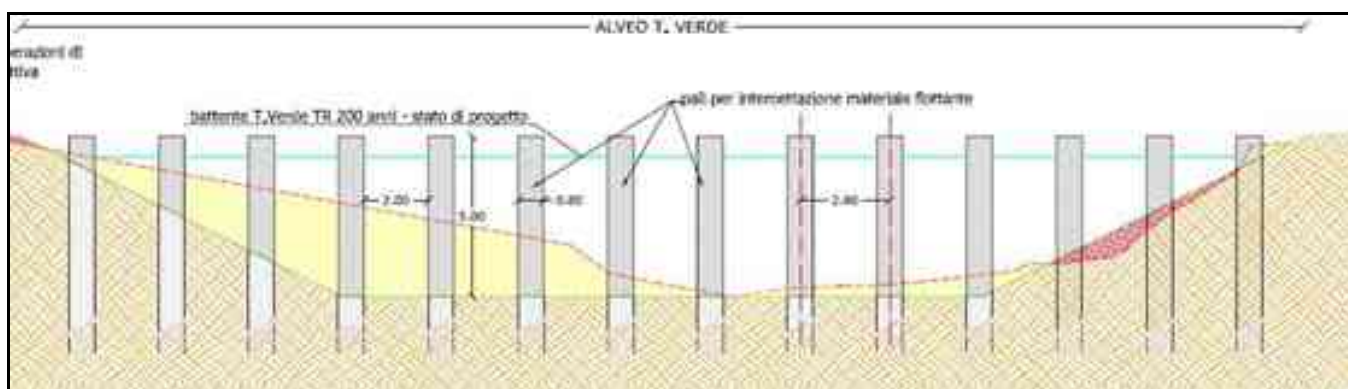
Particolare della briglia estratto dalla tavola allegata
